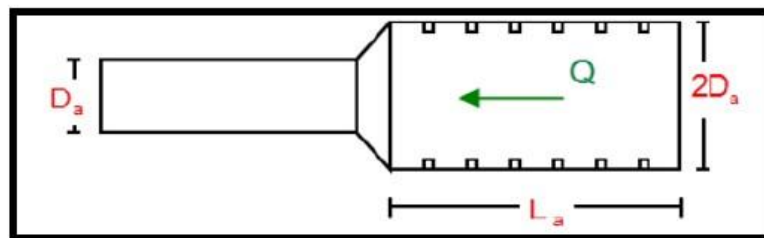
Dimensionamiento de la canastilla. Fuente: Ministerio de vivienda, construcción y saneamiento. (2018)
